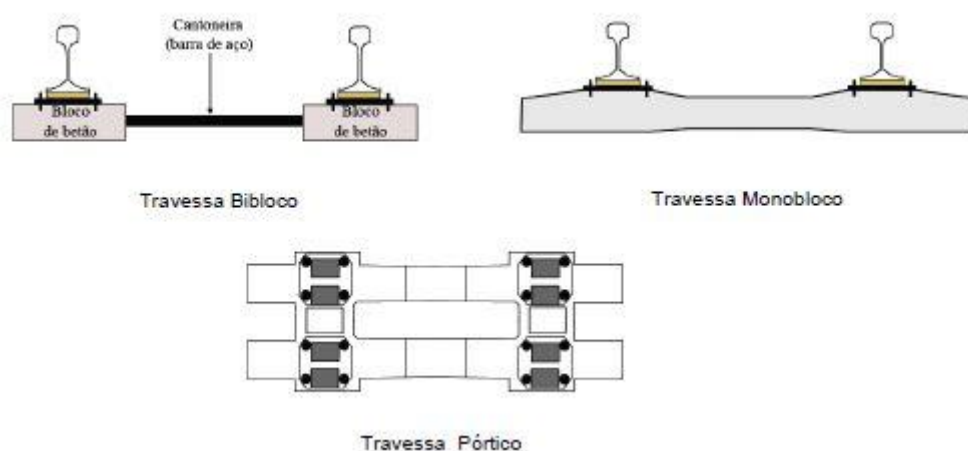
Travessas usadas na ferrovia (Fonte: (10))
